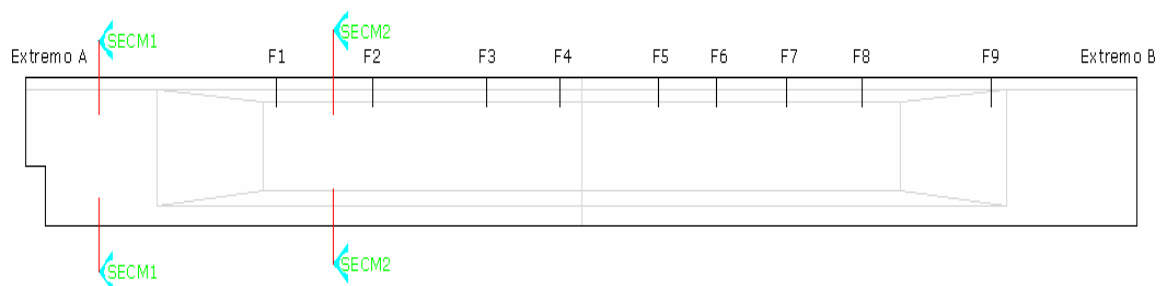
Esquema de localização das fissuras observadas na viga pré-fabricada instrumentada (sem cura térmica)
